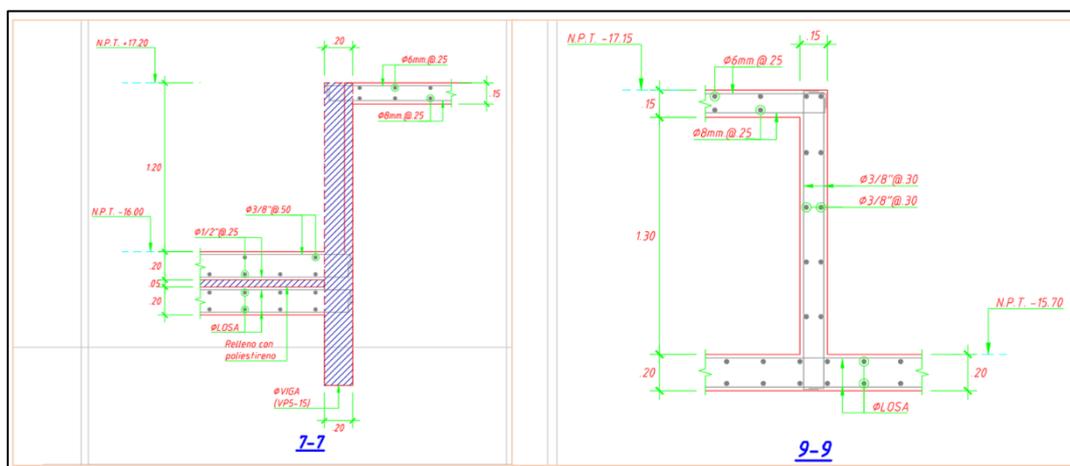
Vista del corte 7-7 y 9-9 del corte en techo en el 5to piso
